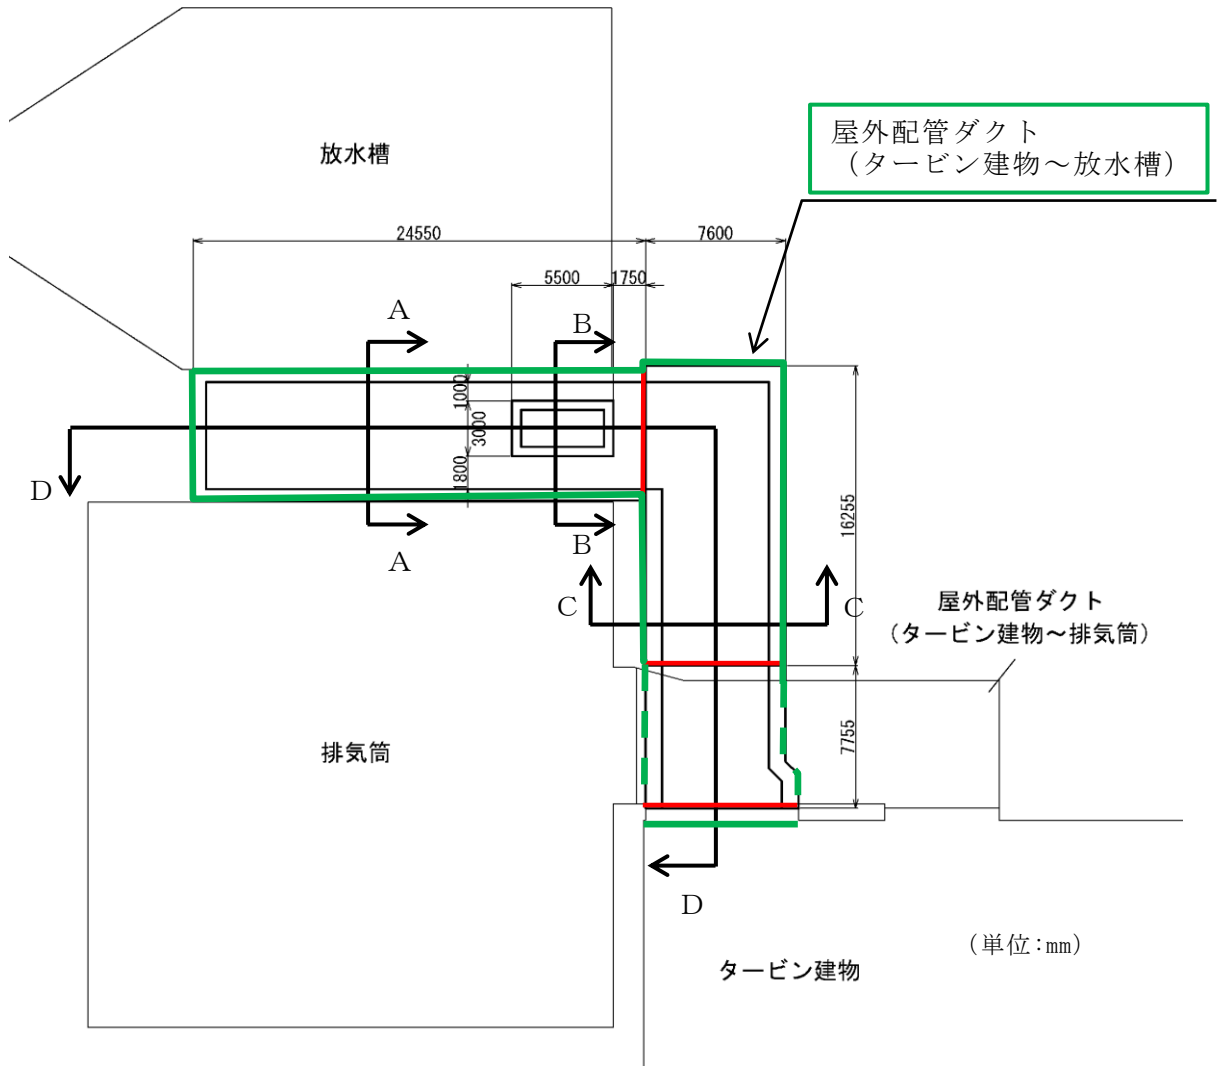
屋外配管ダクト（タービン建物～放水槽） 平面図
